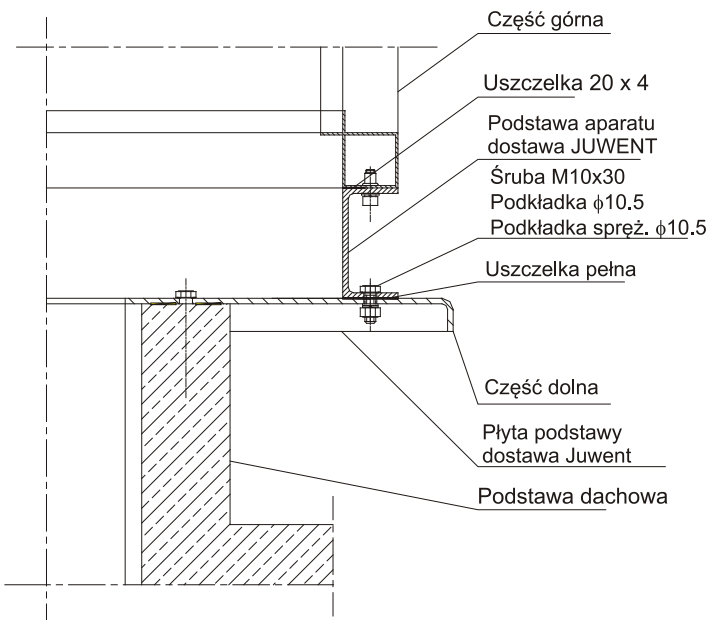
Montaż części wewnętrznej na podstawie dachowej
